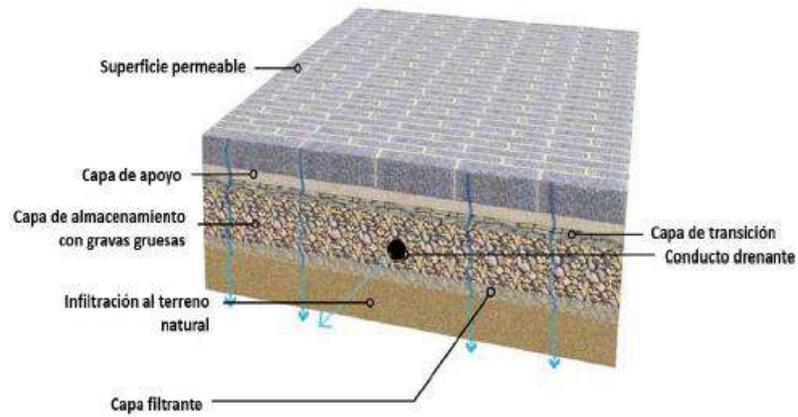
Esquema de un pavimento permeable. Fuente: Adaptado de Washington DC Department of Transportation (2014).
